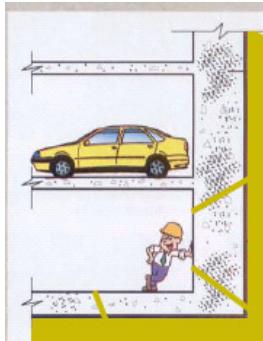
Impermeabilização de paredes diafragma, (ilustração do autor).
